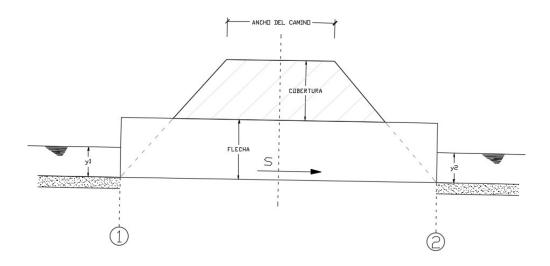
Elementos de perfil de una alcantarilla. Fuente: Elaboración propia adaptado de (Villón, Diseño de estructuras hidráulicas, 2005)
